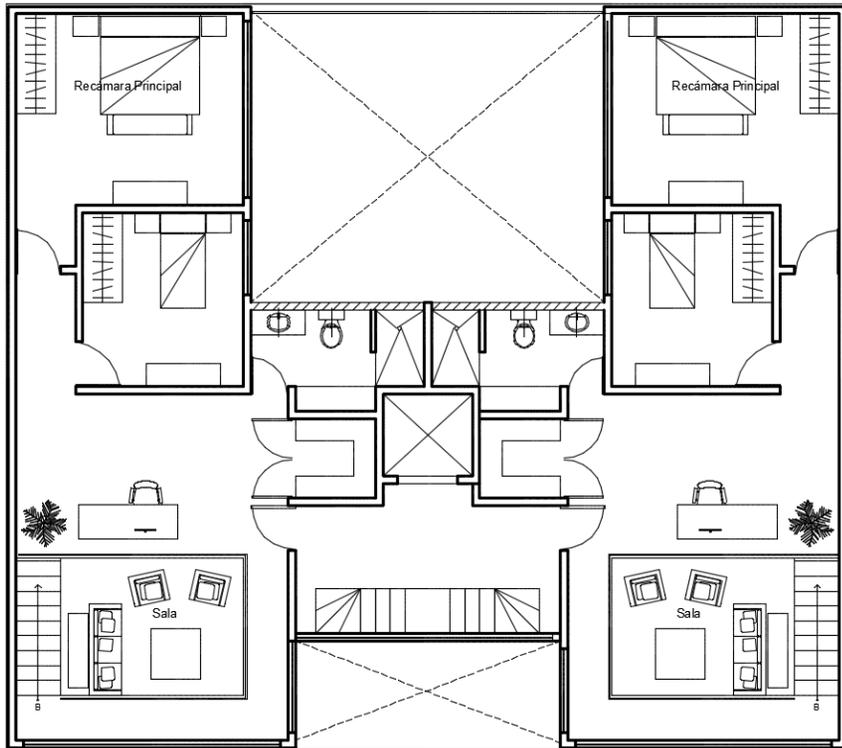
Planta tipo C. Penthouse- planta alta, cuarta hipótesis
